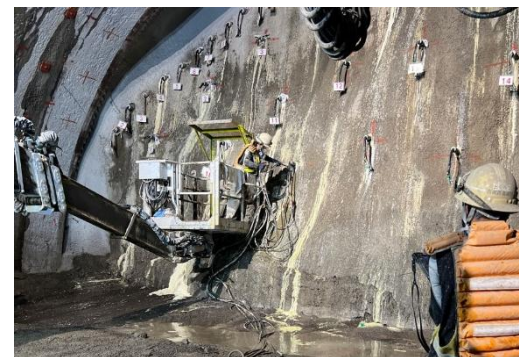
鏡吹付コンクリート、鏡補強ボルトの施工例
